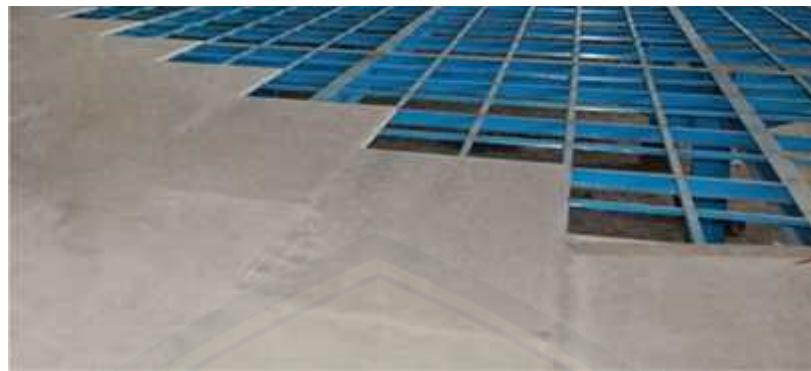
Proyek Lantai 2 bangunan pergudangan
